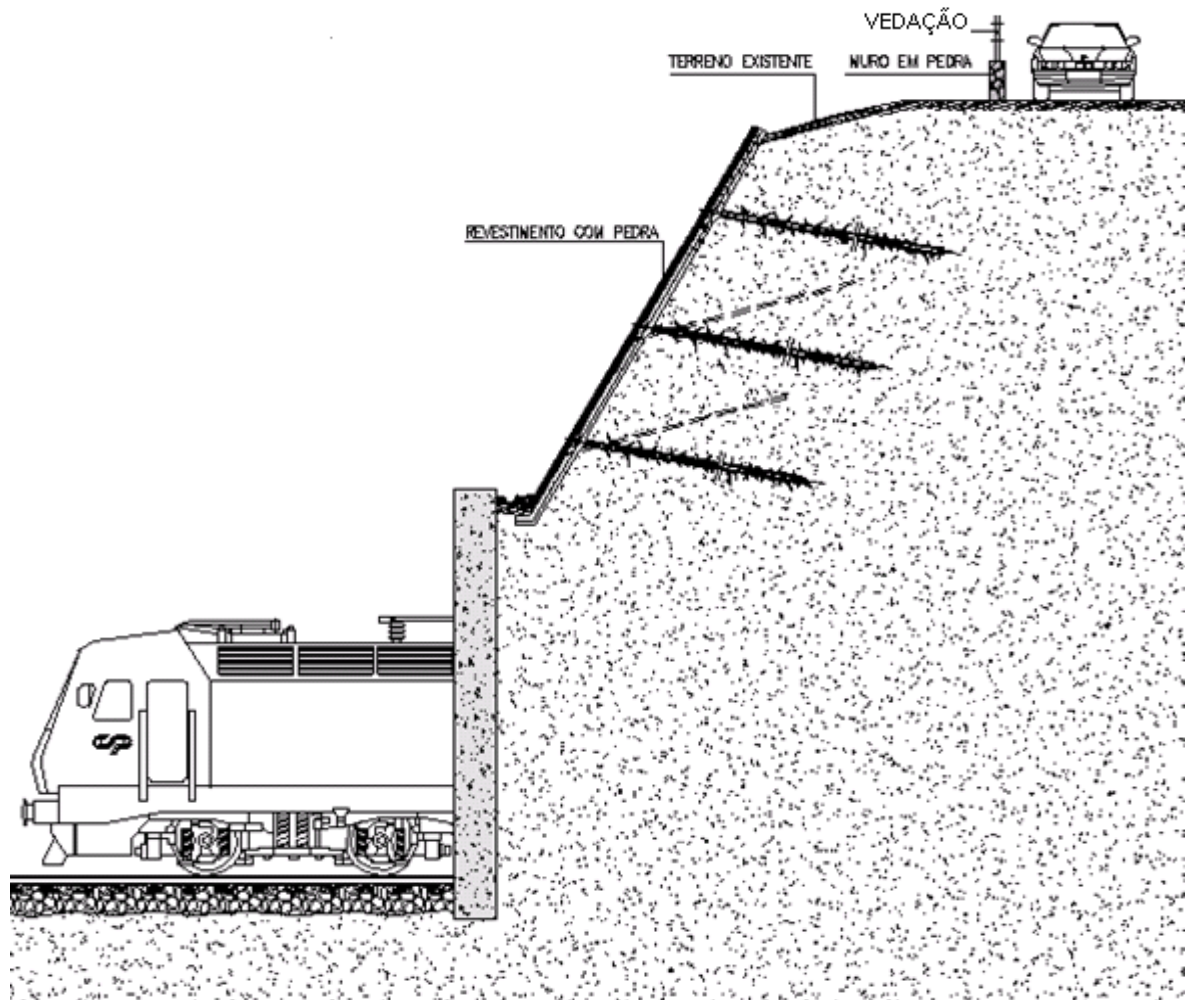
Paramento de betão projectado armado e pregado (GEG)
